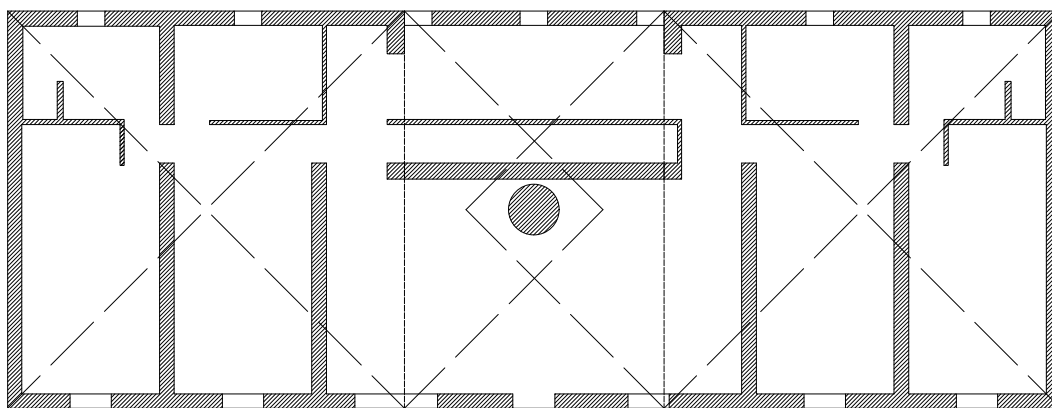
Diagrama de relações espaciais, planta piso térreo casa de Blas (Ilustração nossa, 2018).
